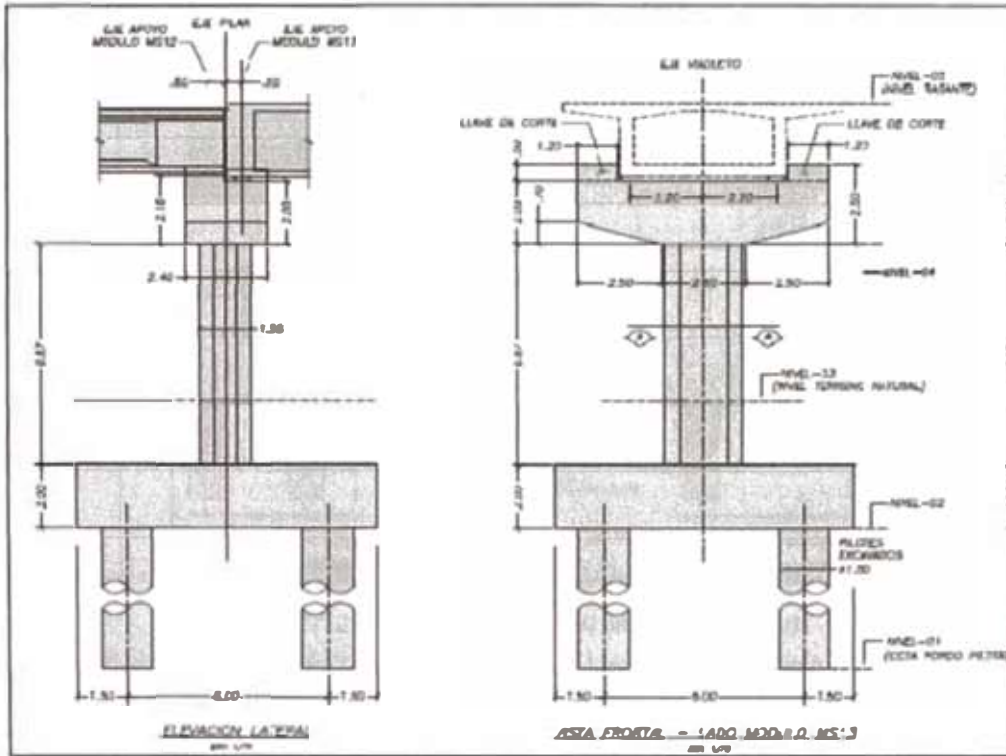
Elevación Pilar S48 (el S52 es similar)
